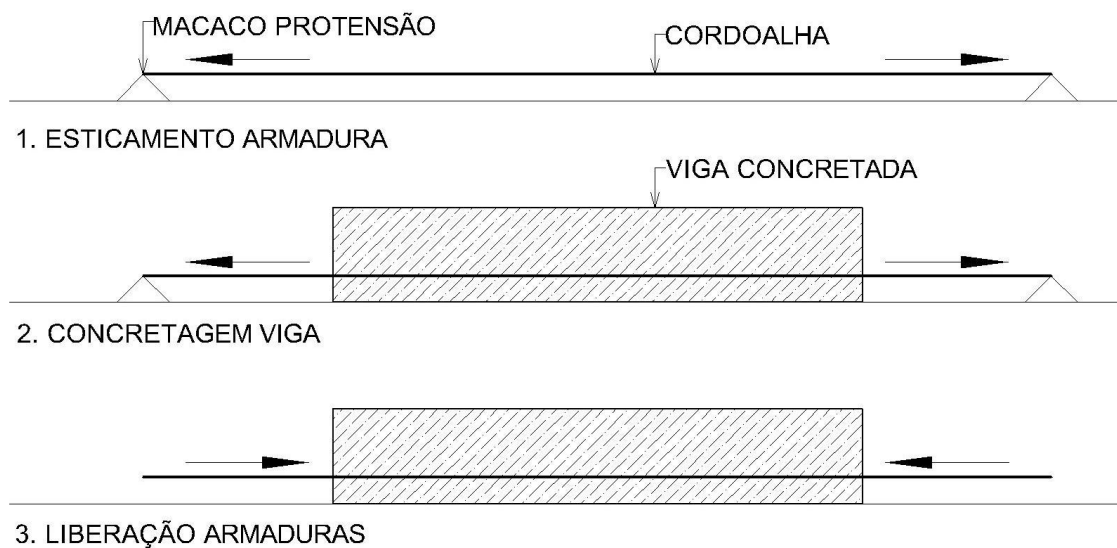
Etapas executivas de uma viga de concreto protendido com pré-tração
